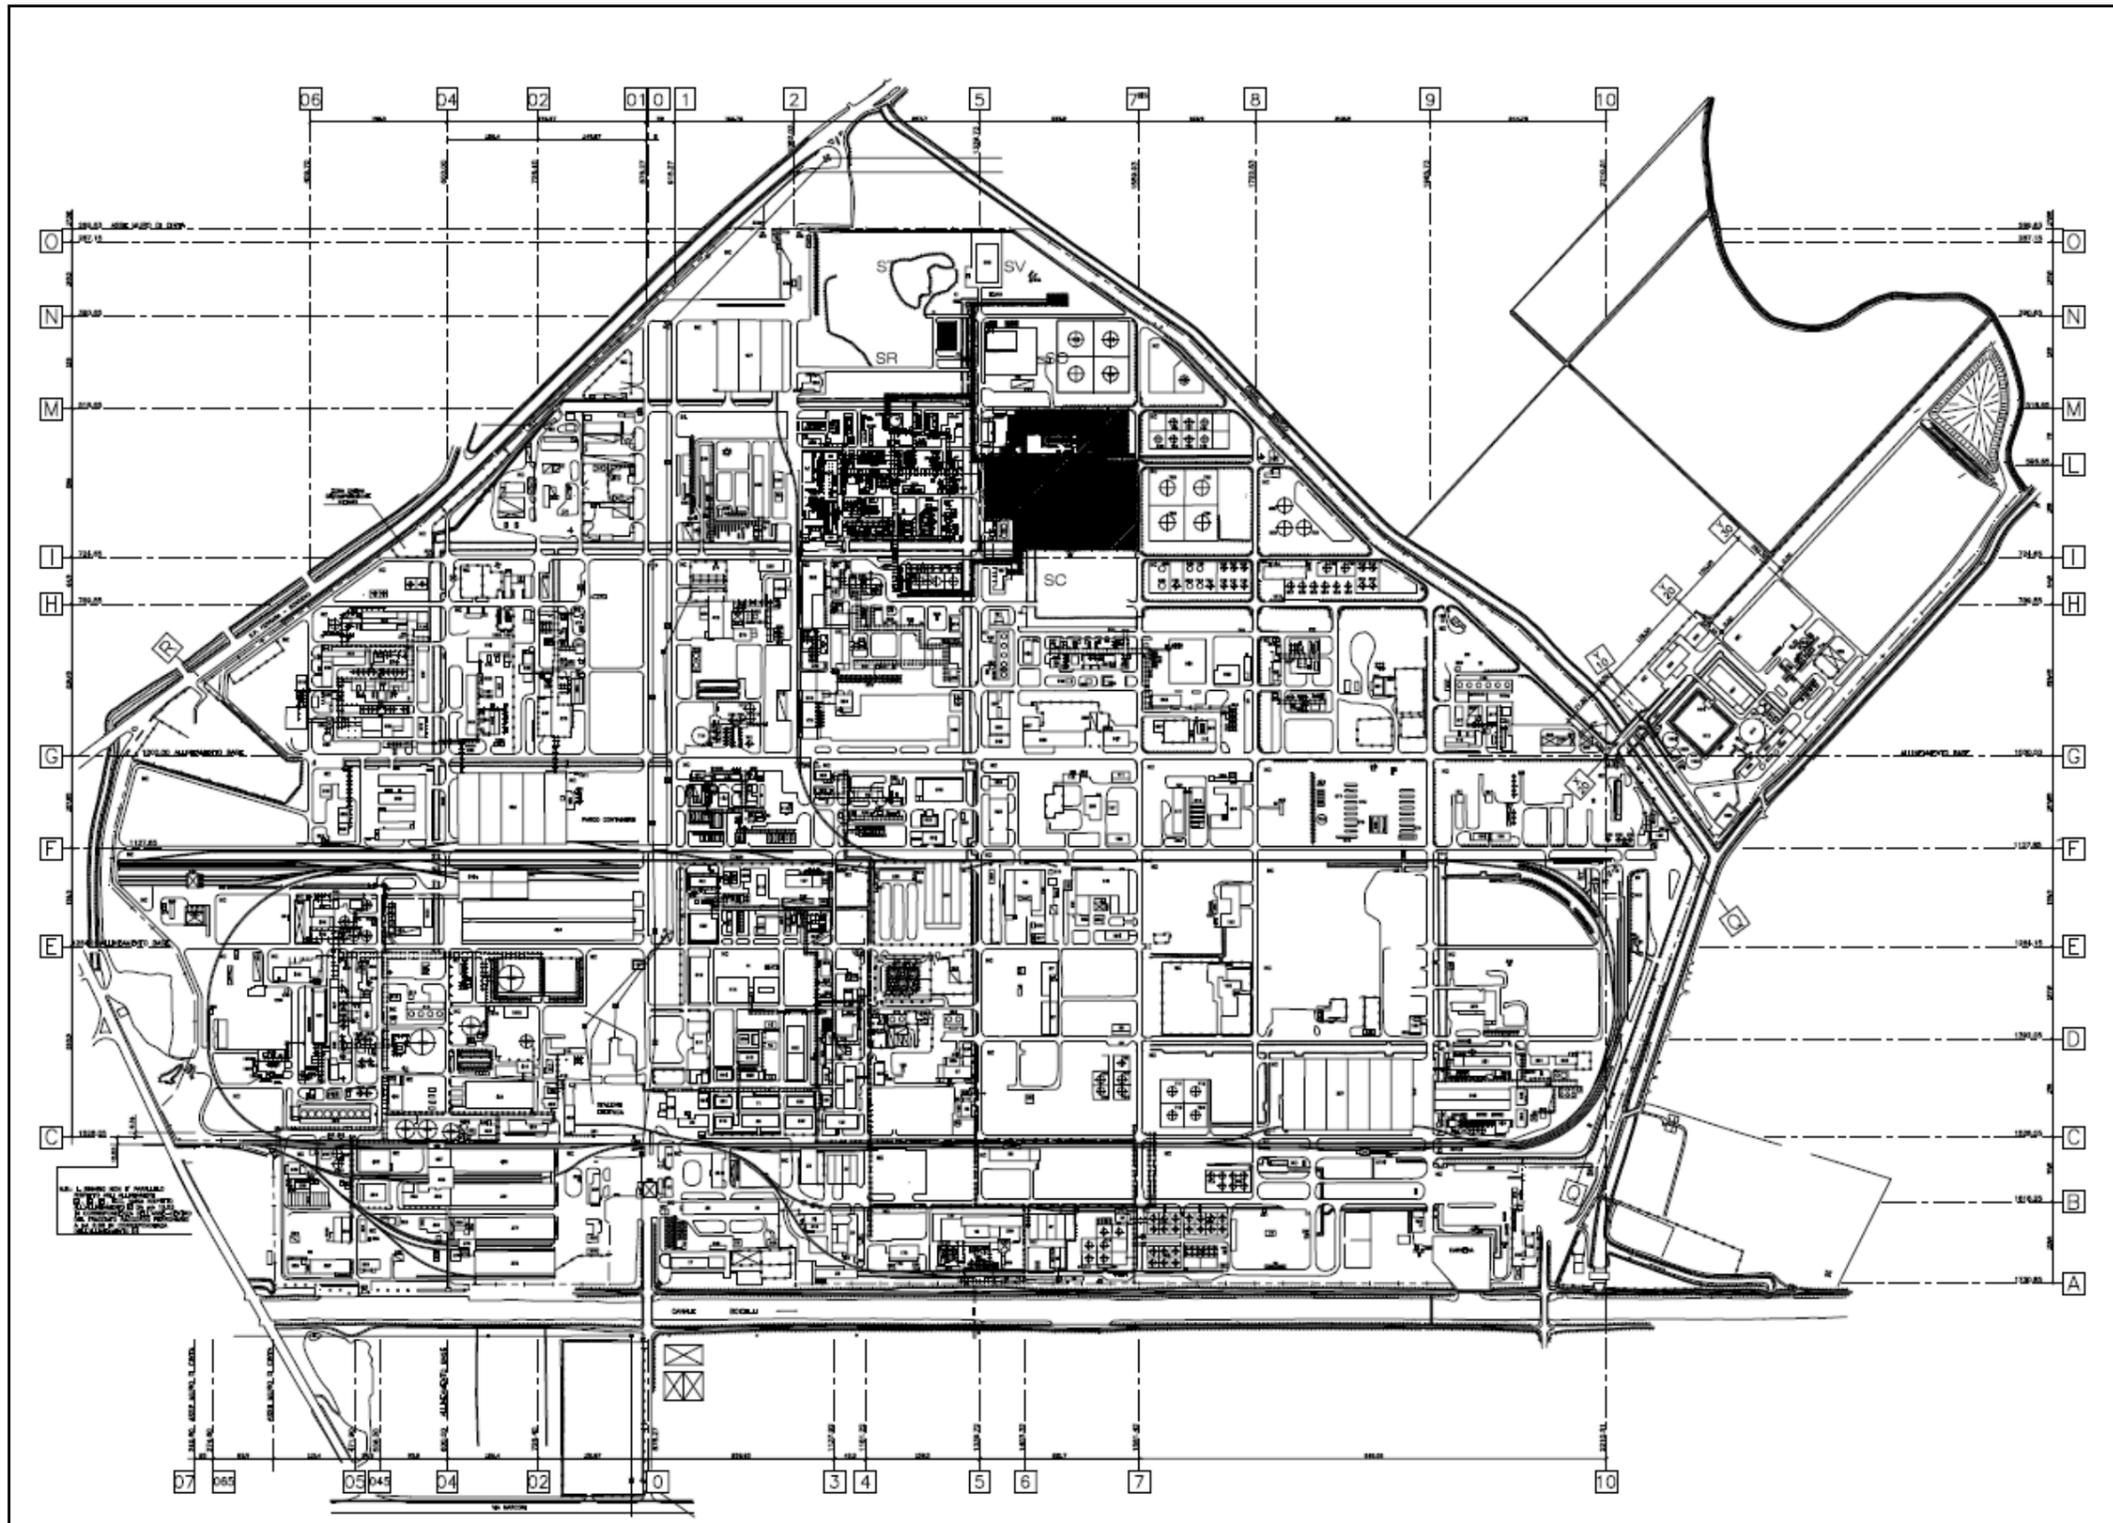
Planimetria dello Stabilimento di Ferrara con evidenziate, con sfondo nero, le aree di intervento
